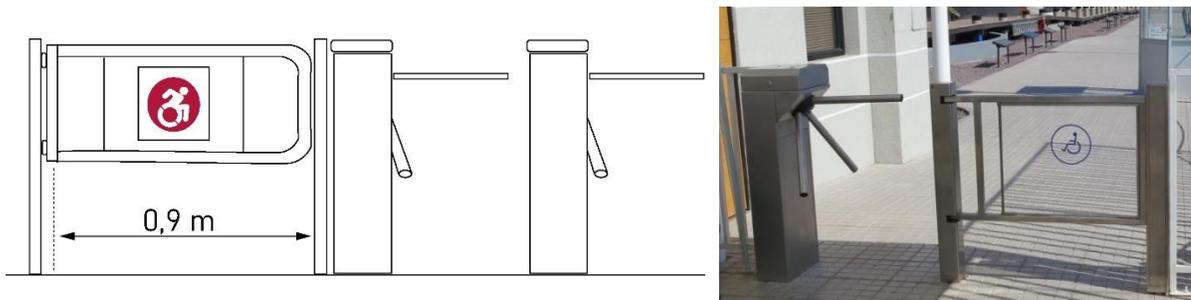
Medidas de control de acceso accesible a la entrada general por torniquetes.
